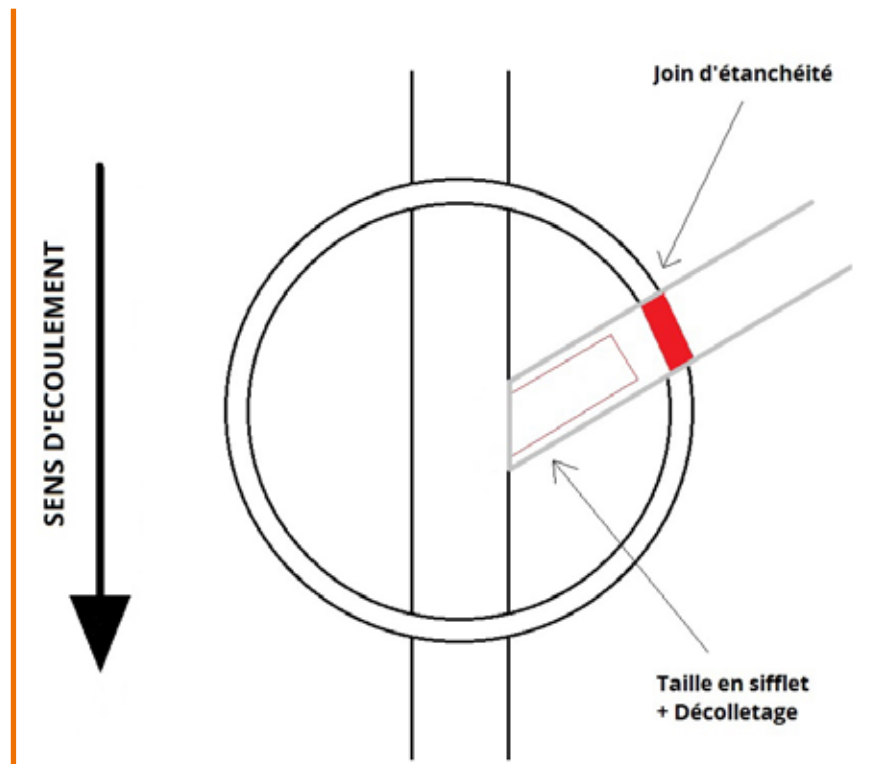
SCHÉMA D'UNE ARRIVÉE SUR BANQUETTE
